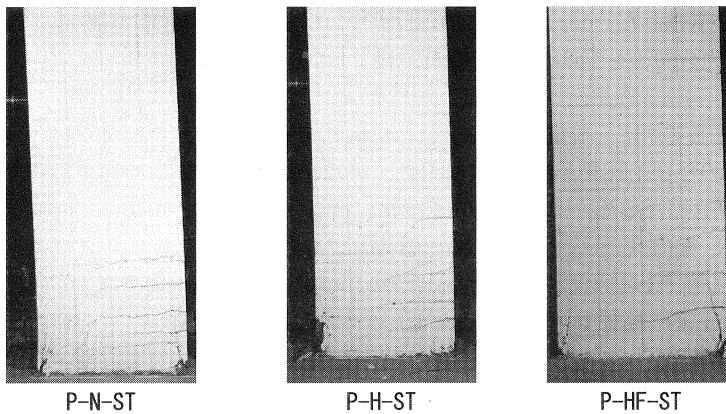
最大耐力付近のひび割れ状況 (+8/200rad時)
